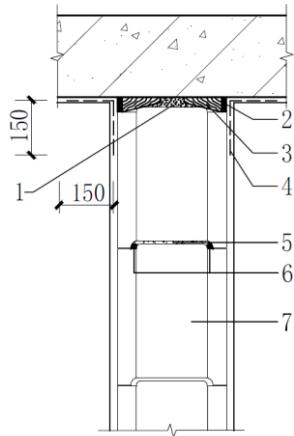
GT 高精度模块墙体与梁或顶板连接示意图（刚性连接）
